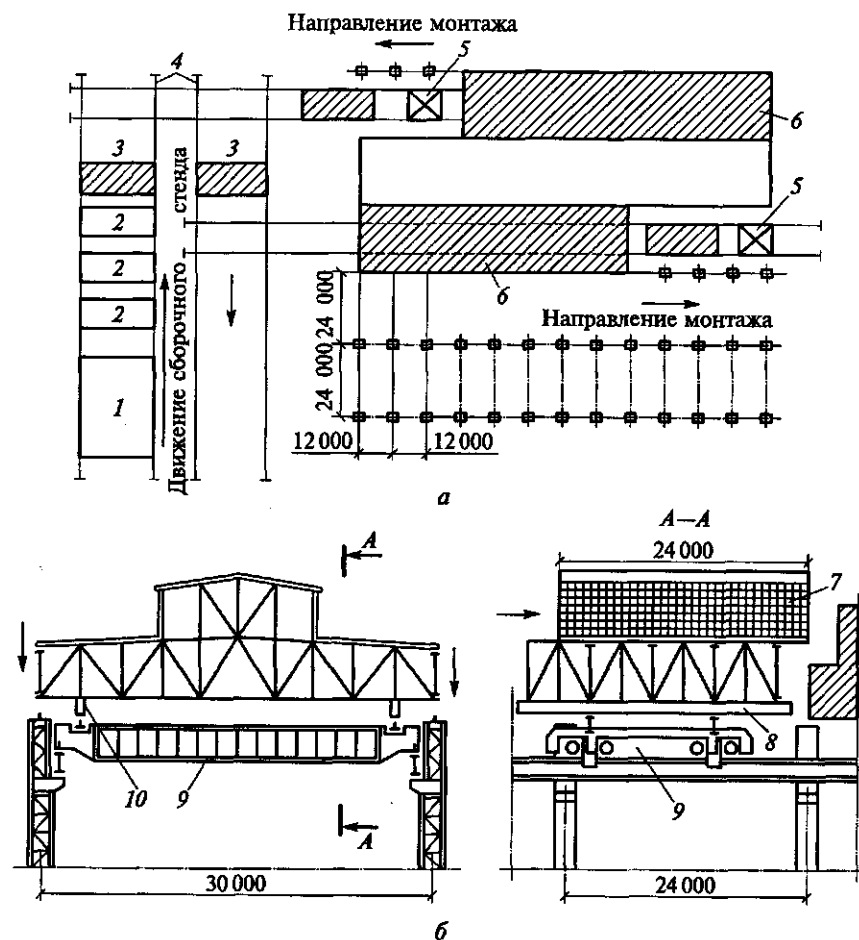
Конвейерно-блочный монтаж конструкций покрытия:
